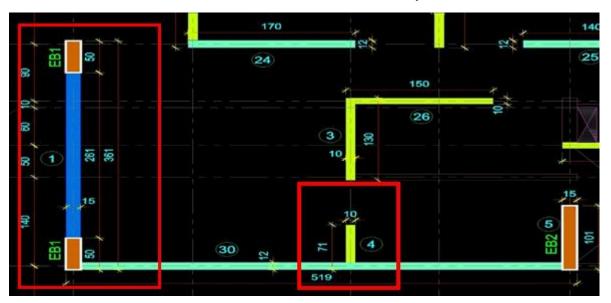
Secciones y perfil del muro 1 (doble malla)
